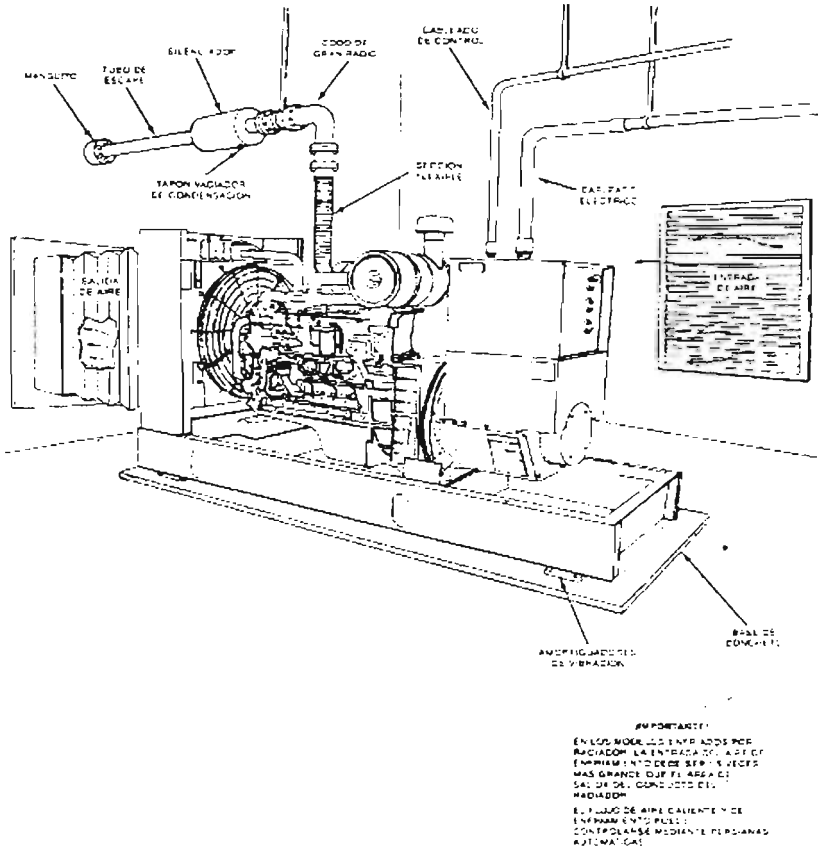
Vista del sistema de ventilación para un equipo electrógeno.
